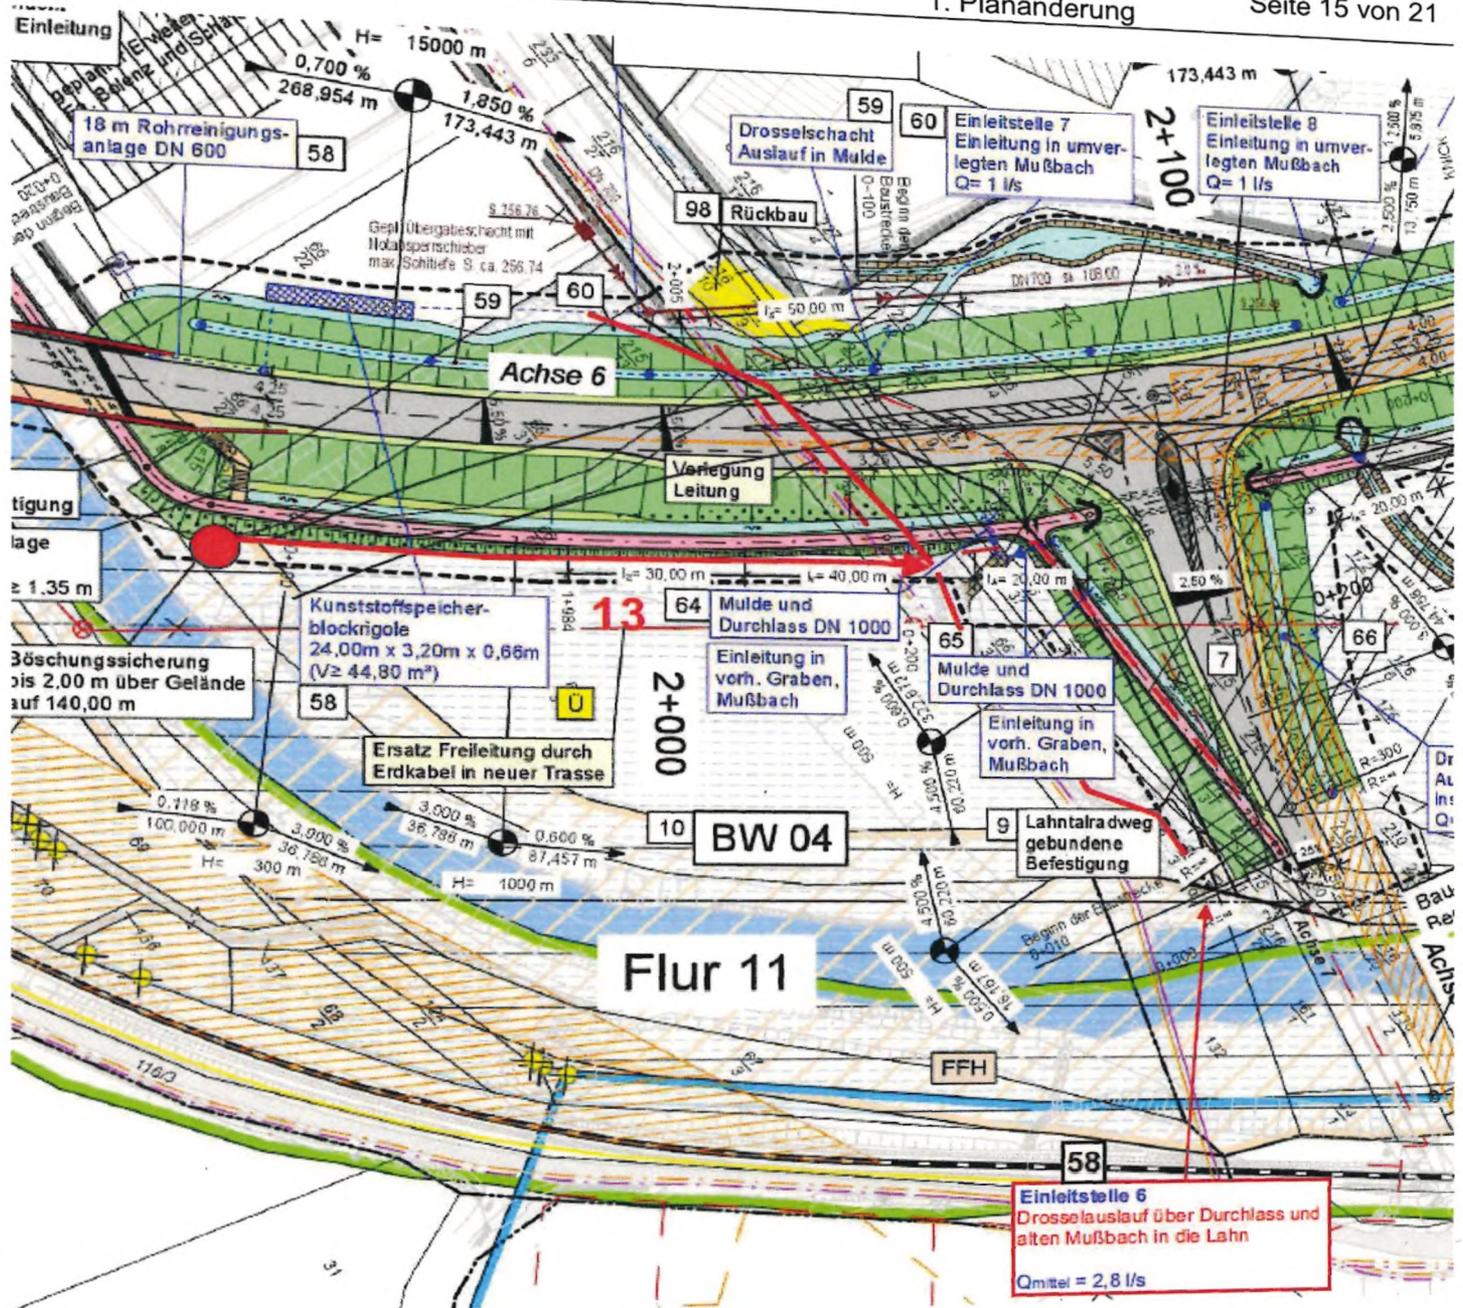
Geplante Einleitstelle 6 auf Lageplan 4
